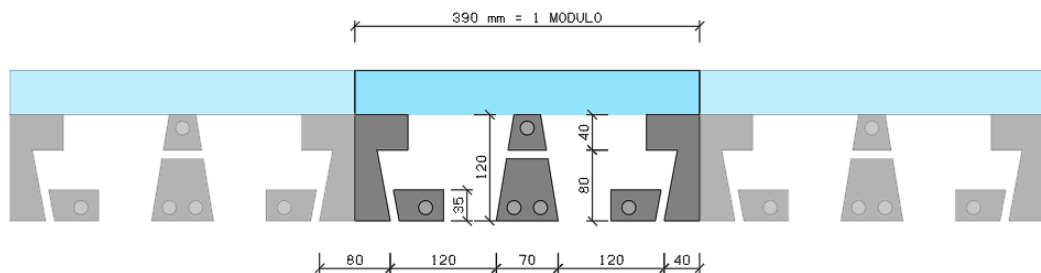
Aree di calcestruzzo nel solaio SAP12+5
